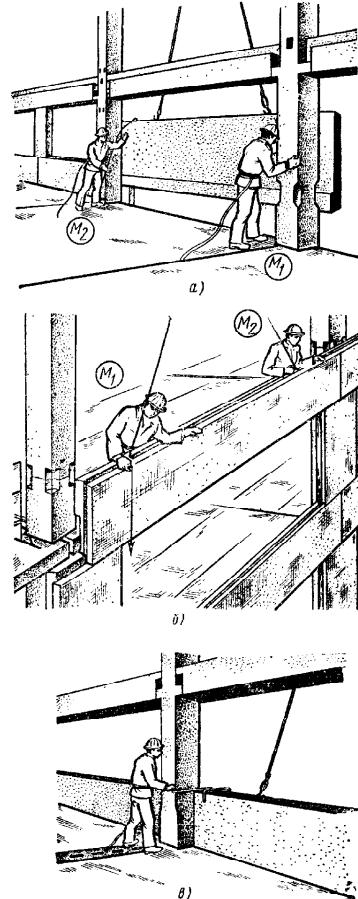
Монтаж наружных ленточных панелей в каркасных зданиях:
